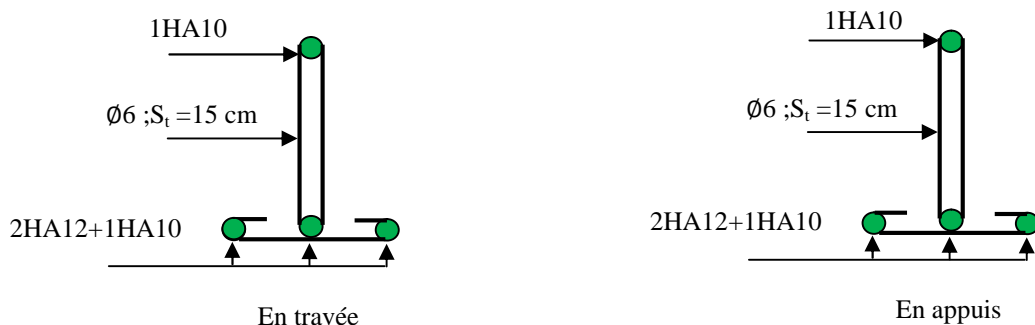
Schéma de ferrailage des poutrelles plancher RDC.
